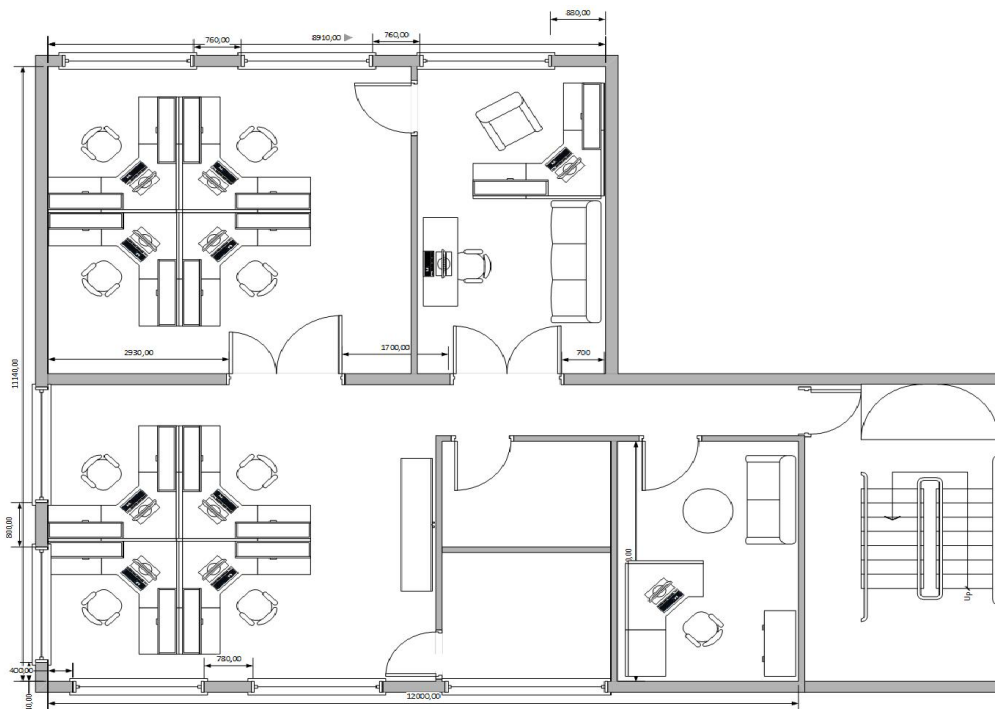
Схематичний план розташування приміщень 2-го поверху
